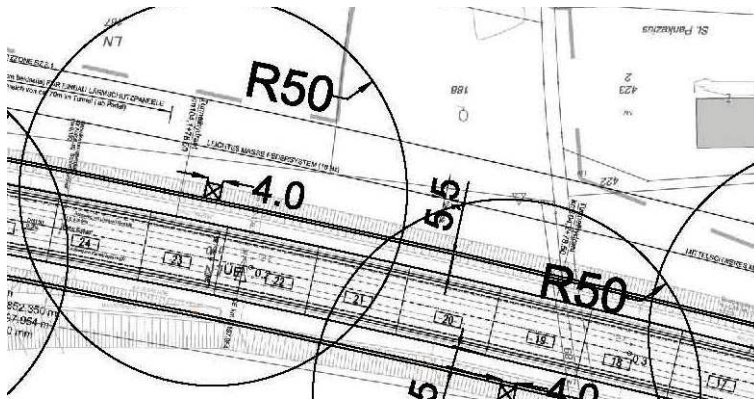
Positionierung des Kranes außerhalb der Baustraße
